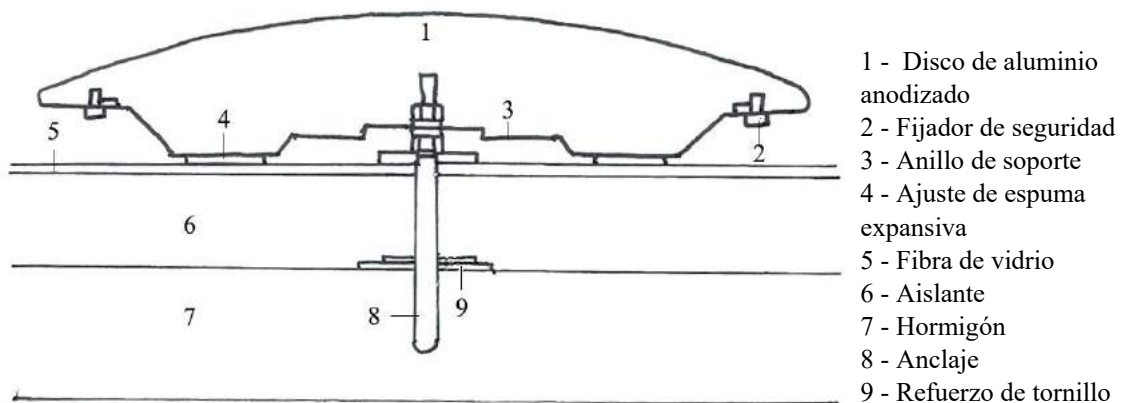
Detalle anclaje del disco de aluminio al muro estructural [55]
